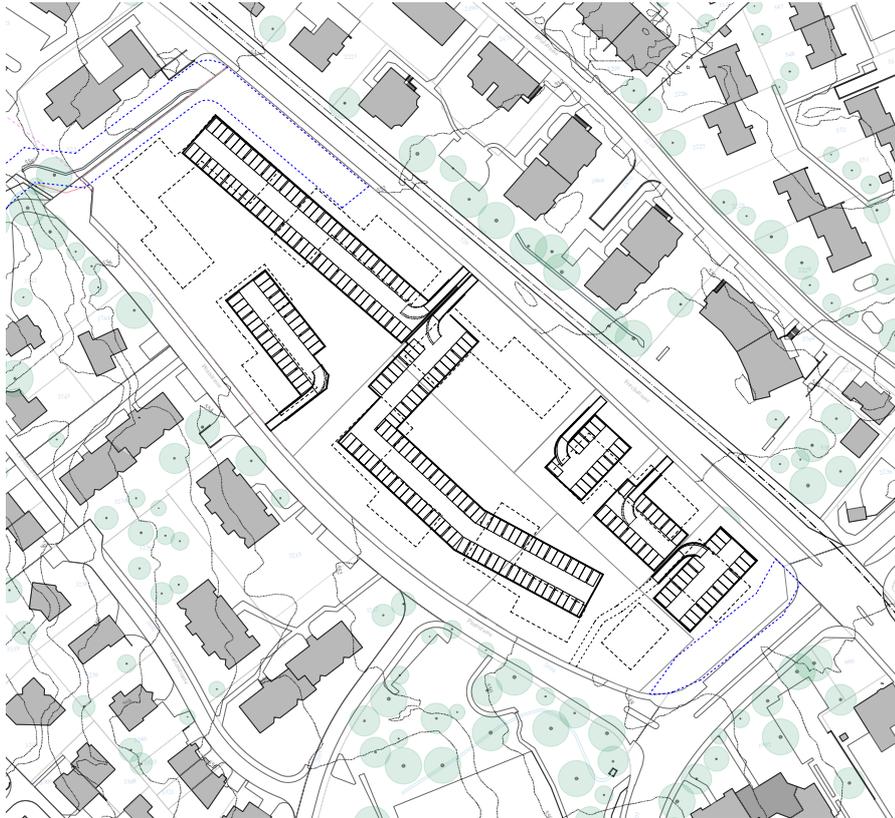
Erschliessungsvariante der Grundstücke unabhängigen Zufahrten je Grundeigentümer
